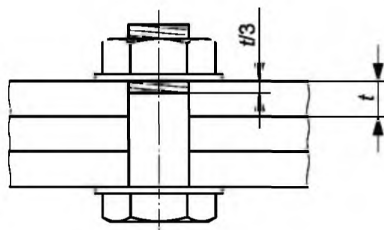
Рабочая длина резьбовой части стержня призонных болтов
